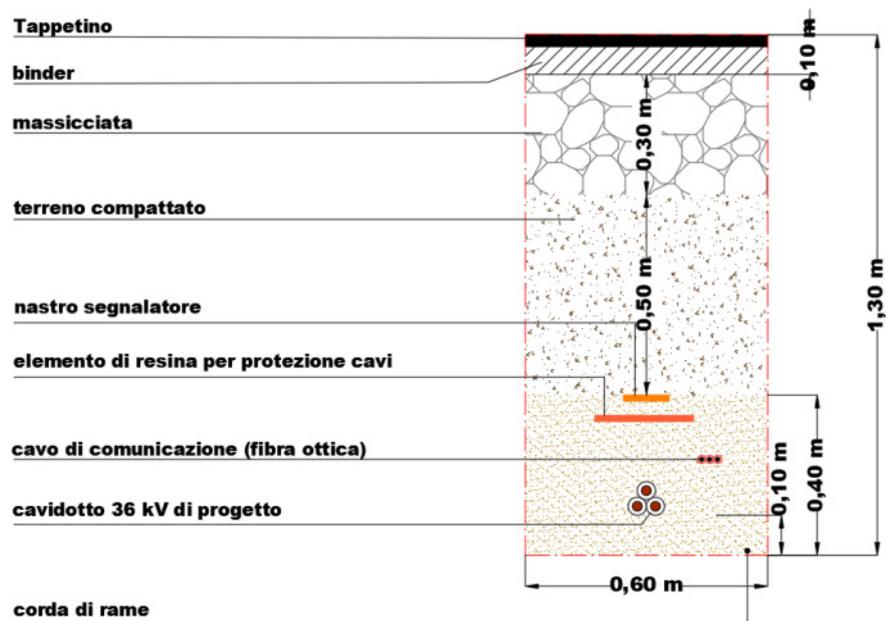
Sezione del cavidotto singola Terna su strada asfaltata
